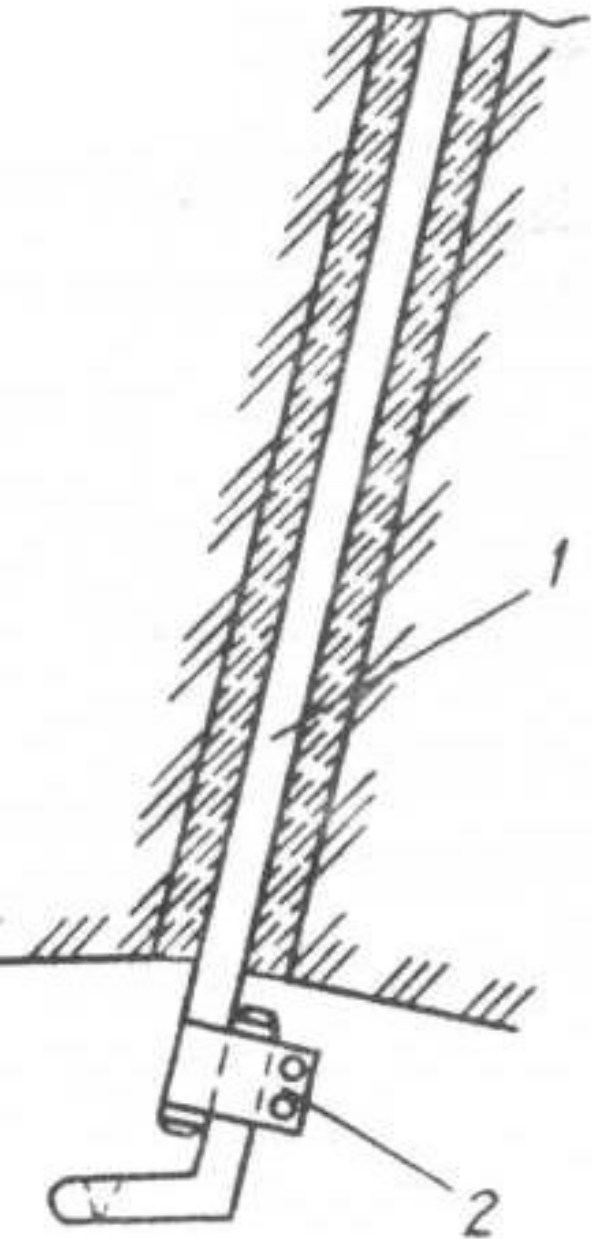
Типы реперов в кровле горных выработок - на штанговой крепи
